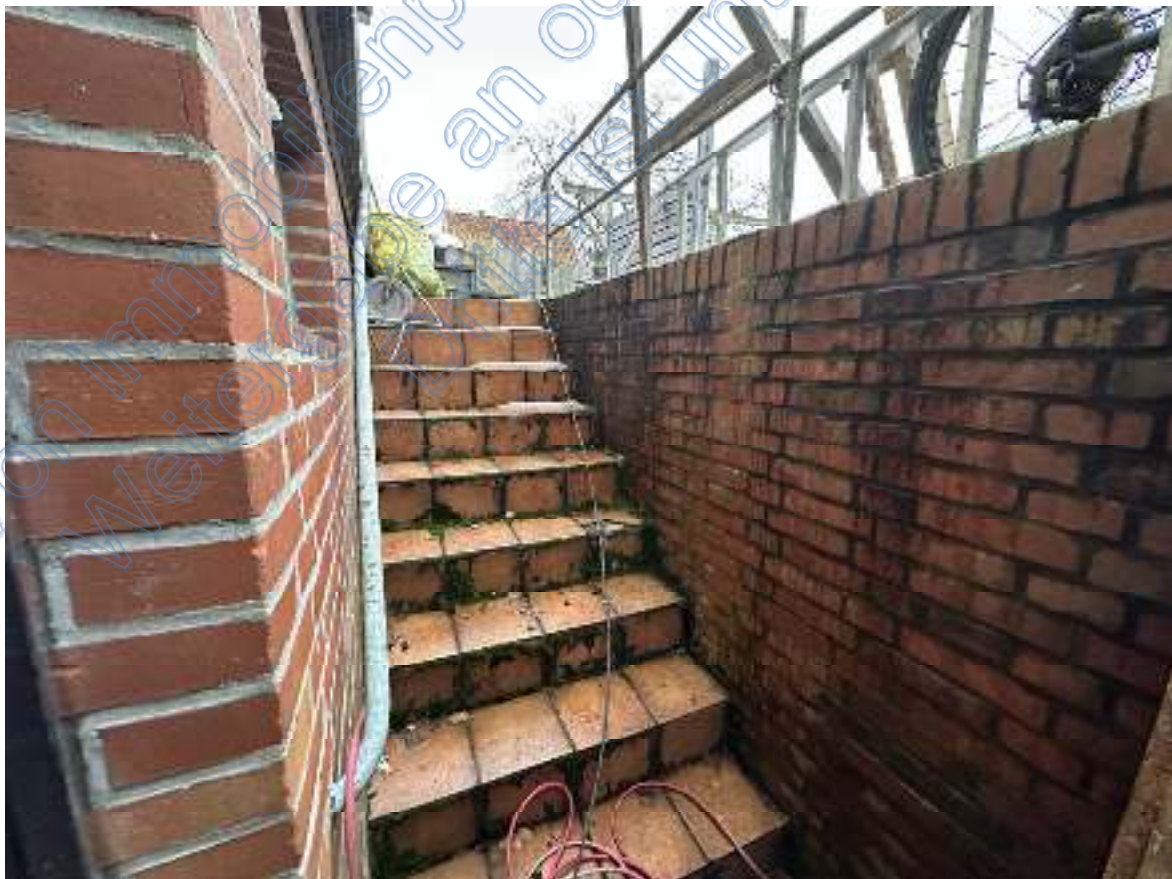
Ausschnitt – Kellertreppe (Wohnhaus KG Richtung rückwärtige Grundstücksfläche & zur Freisitzüberdachung).
